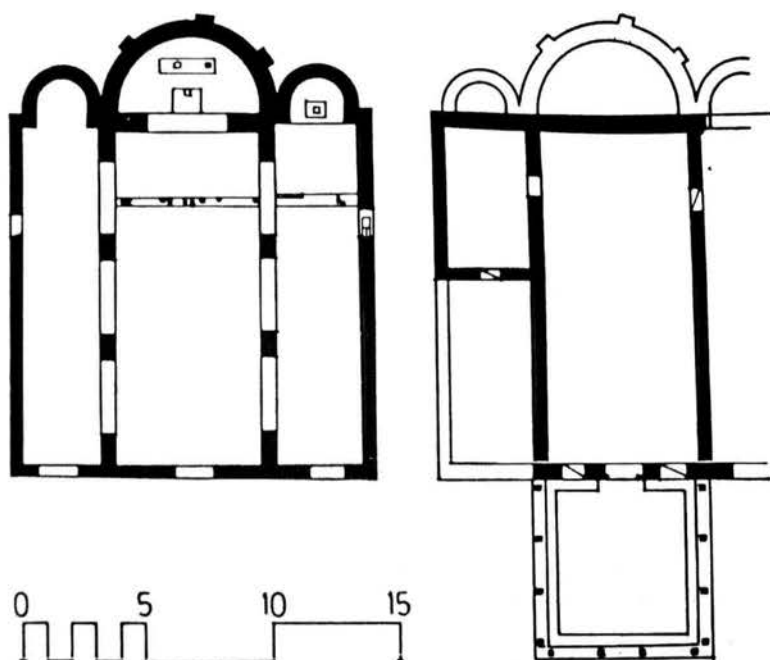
San Quirino: pianta della basilica (seconda metà del VI secolo)
